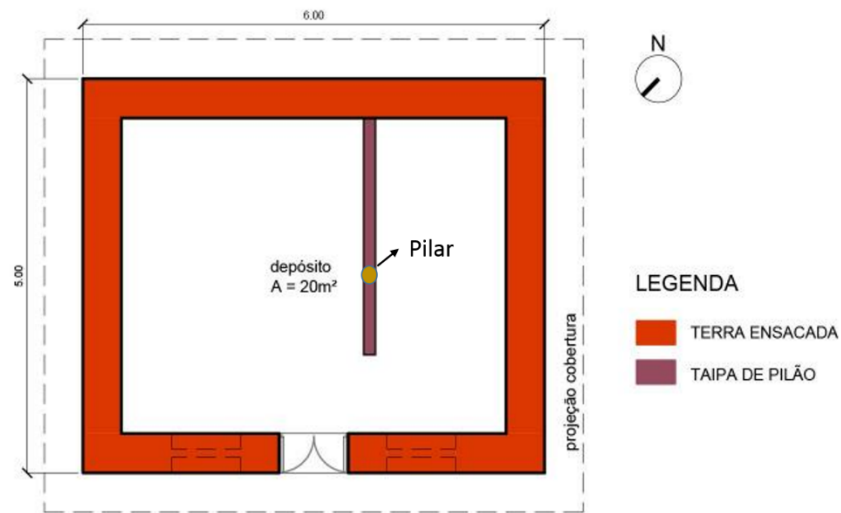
Planta baixa Edificação 01. Fonte: Autora.
